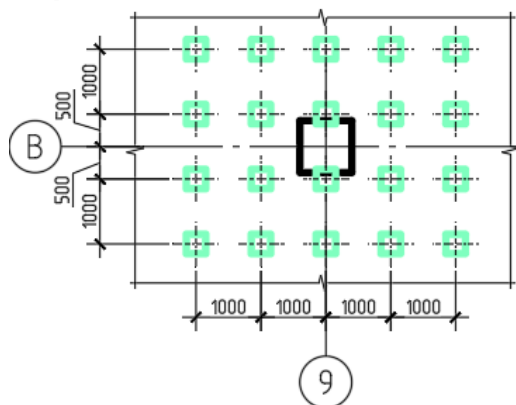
Схема расположения свай под фрагмент плитного фундамента
